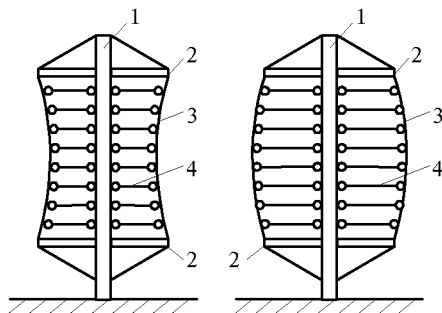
Высотные здания с жестким стволом и подвешенными на предварительно напряженных вантах этажами
